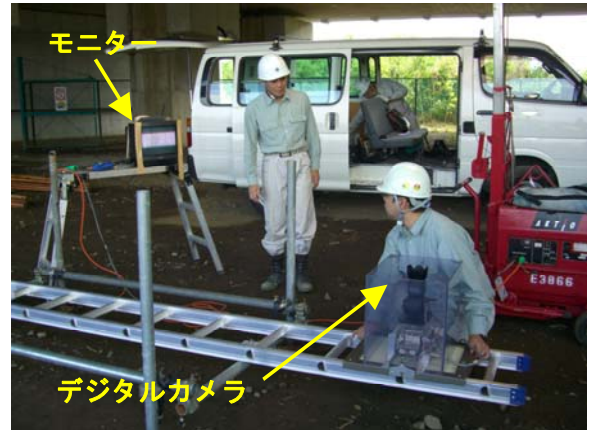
ひび割れ画像撮影状況（拡大）
